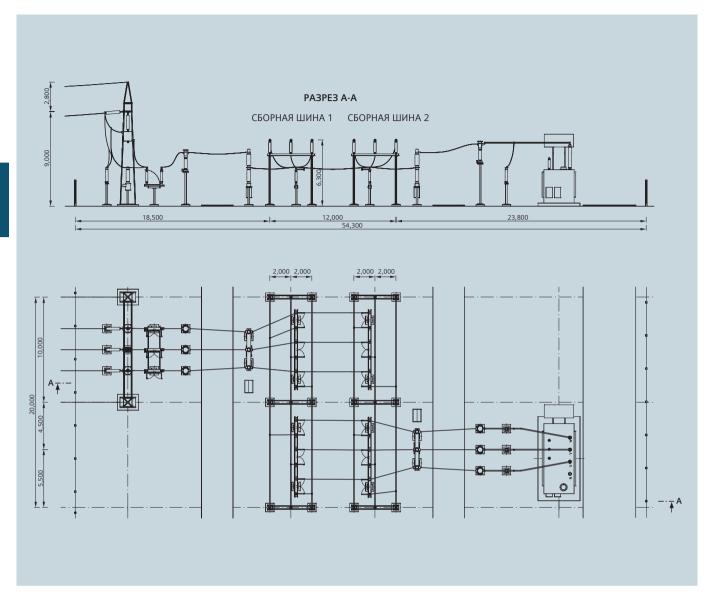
Продольное расположение оборудования, РУ 110 кВ
